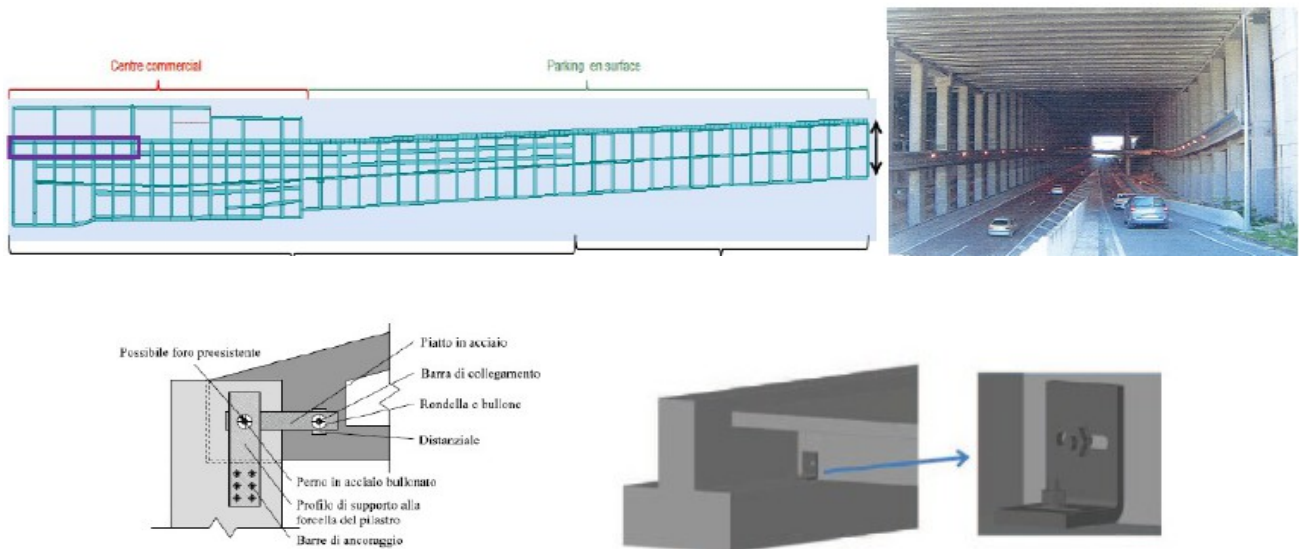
Diagnostic et projet de renforcement sismique du Centre Commercial du Merlan (L2 – Marseille) et principe de liaisonnement des ossatures poteaux-poutres (sur le principe de la documentation technique italienne pour le renforcement des structures industrielles)
